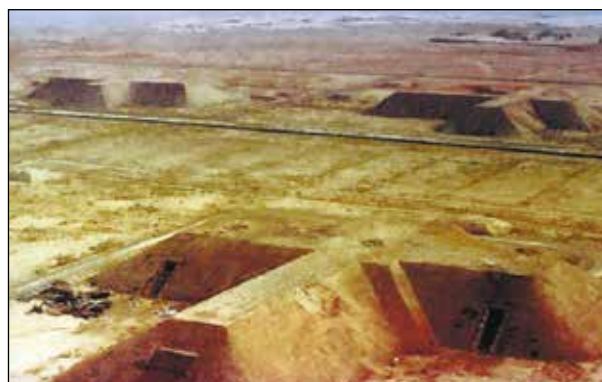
Бункеры временного хранения химического оружия в Самарре [19] (Полуподземные сооружения, напоминают усеченную пирамиду. Основное хранилище заглублено на 5 м ниже уровня земли, размеры – 60x18x10 м. Стены и крыша сооружены из железобетона толщиной 1 м. Кровельная плита была покрыта трехметровым слоем песчаной глины. Каждый бункер имел два боковых входа, которые позволяли персоналу добраться до основной камеры. Основное хранилище было защищено от внешних взрывов усиленными дверями. Имелись аварийный генератор, топливный бак, компрессор и охлаждающий блок)
